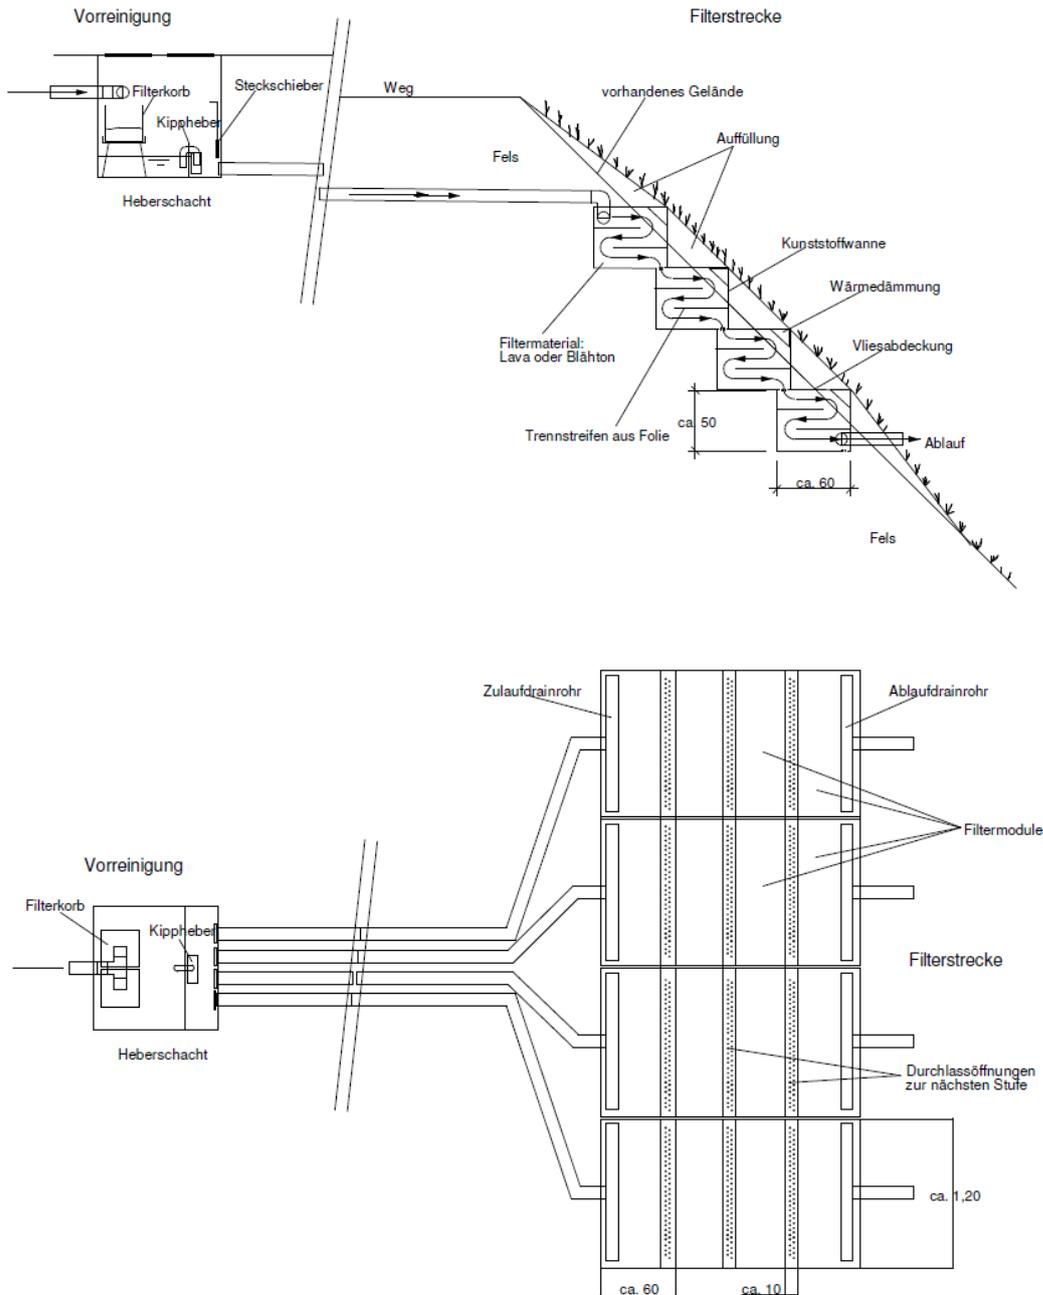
Auf- und Grundriß der Abwasserreinigungsanlage
